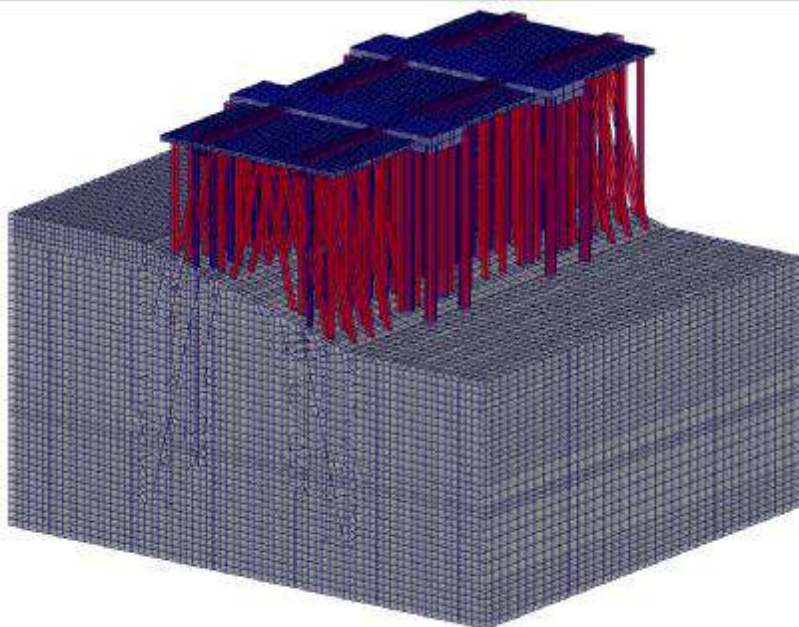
Просторова розрахункова схема . Загальний вигляд..
